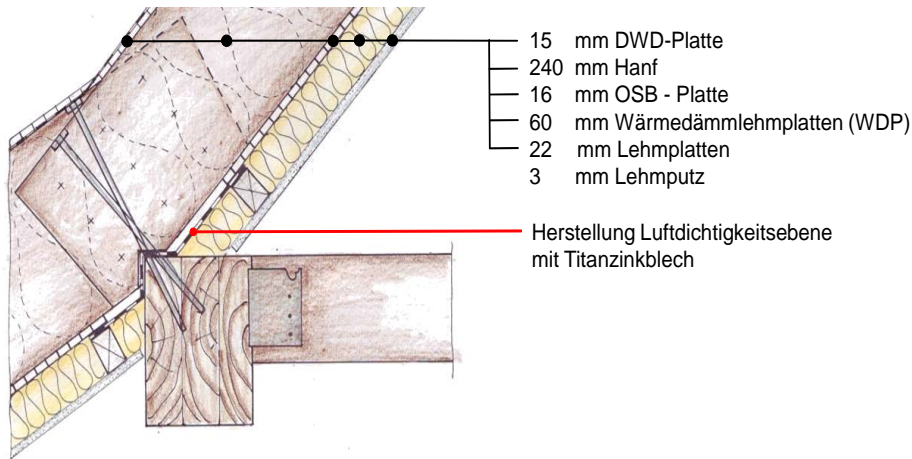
Dach, Detail, Sparren/ Petteanschluss mit Dachaufbau und Herstellung der Luftdichtigkeit
